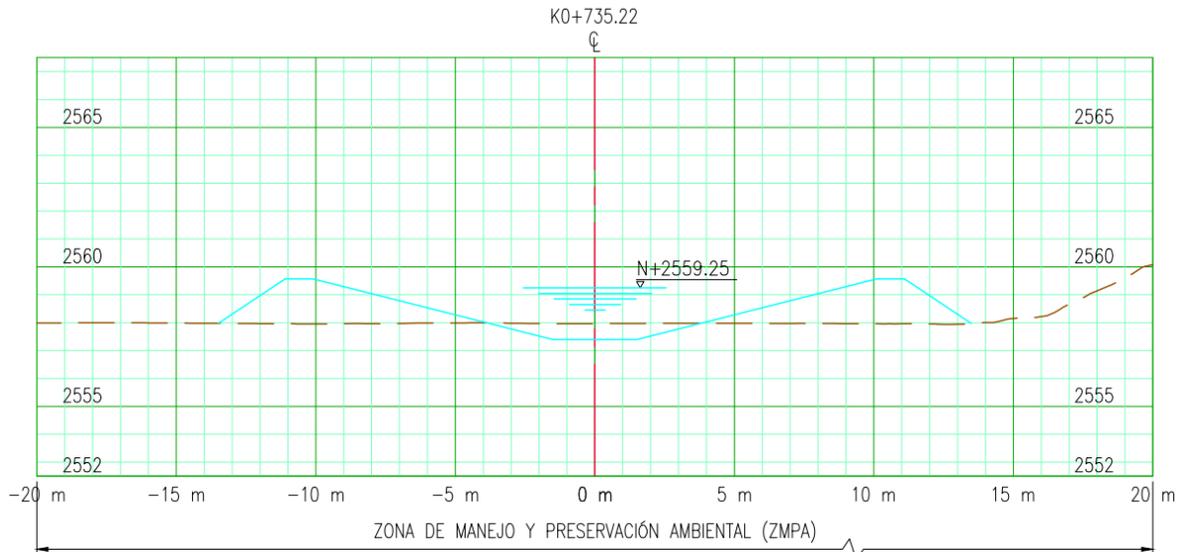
Perfil Quebrada la Pilas. Punto de inicio reconfiguración.
